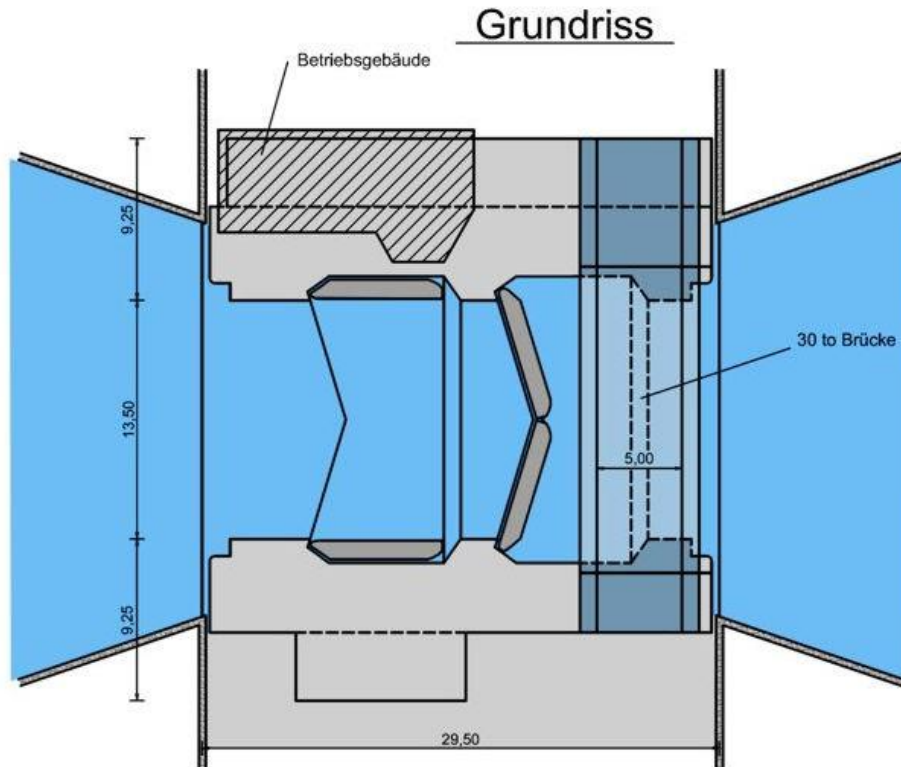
Grundriss Sperrwerk Abbenfleth
